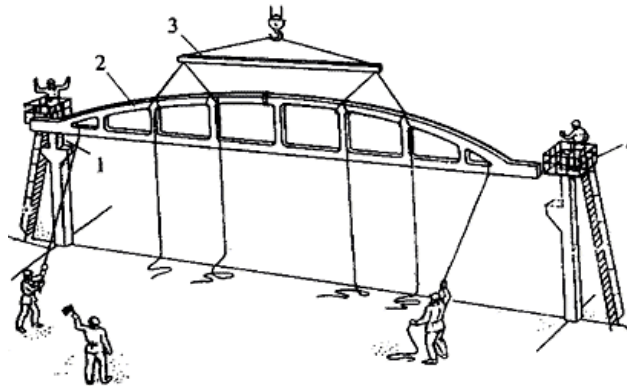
Монтаж и закрепление фермы на опорах колонны
